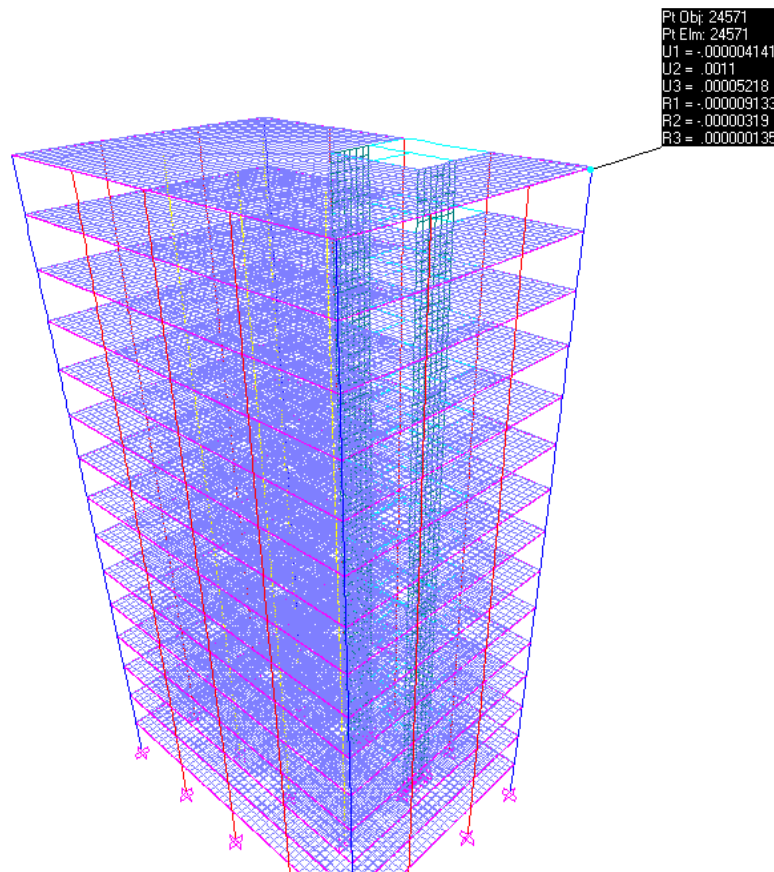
Deslocamento horizontal (m e rad) no topo dos pilares para força na direção y
